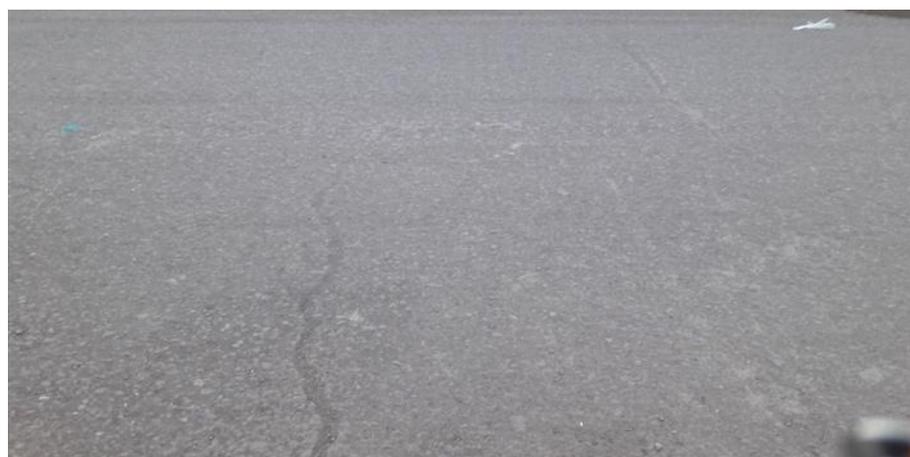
9. Falla Grietas de Reflexión de Juntas, Avenida Mariano Núñez.
